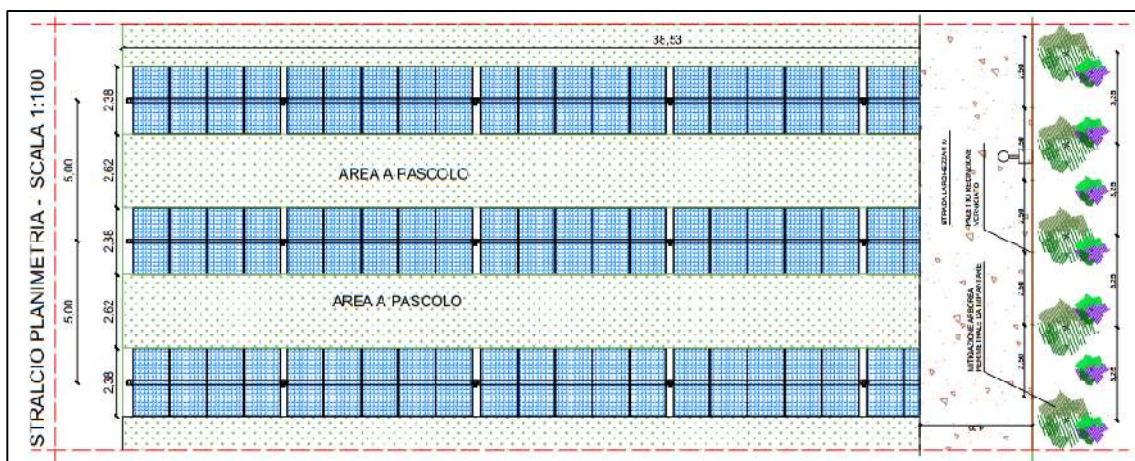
Stralcio planimetrico dell'impianto agrivoltaico.
